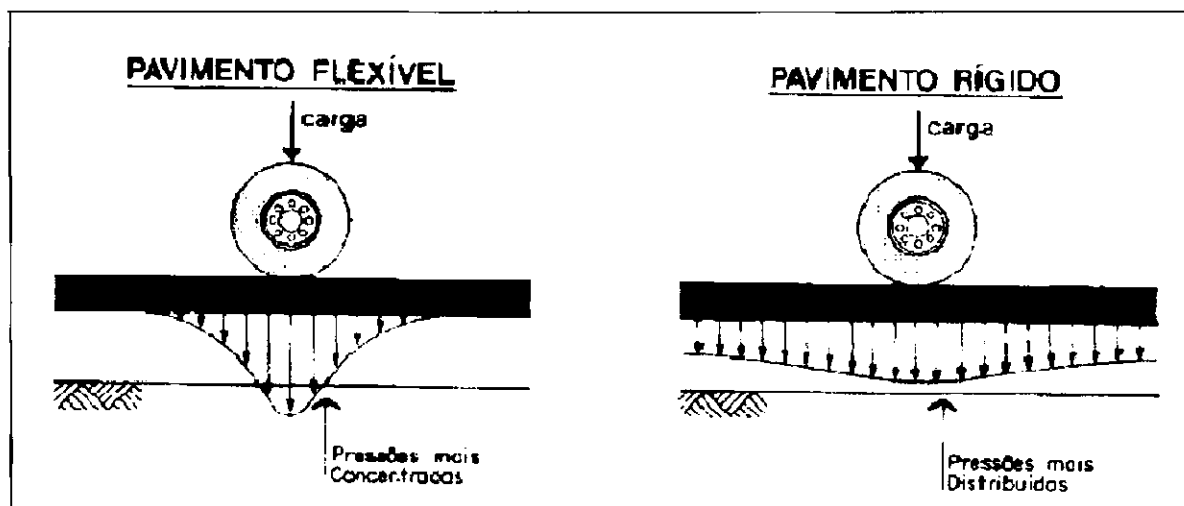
Distribuição de pressões em estruturas de pavimento.
